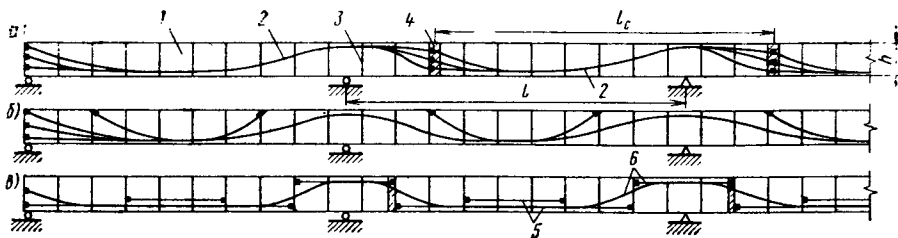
Схемы продольного армирования сборных ребристых пролетных строений:
